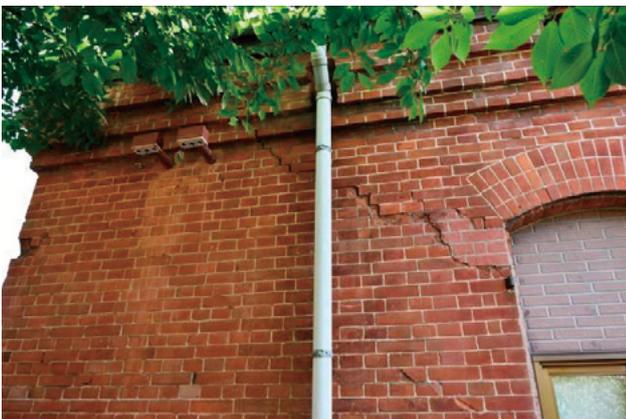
現在の施設課事務所東北側壁面のひび割れ
